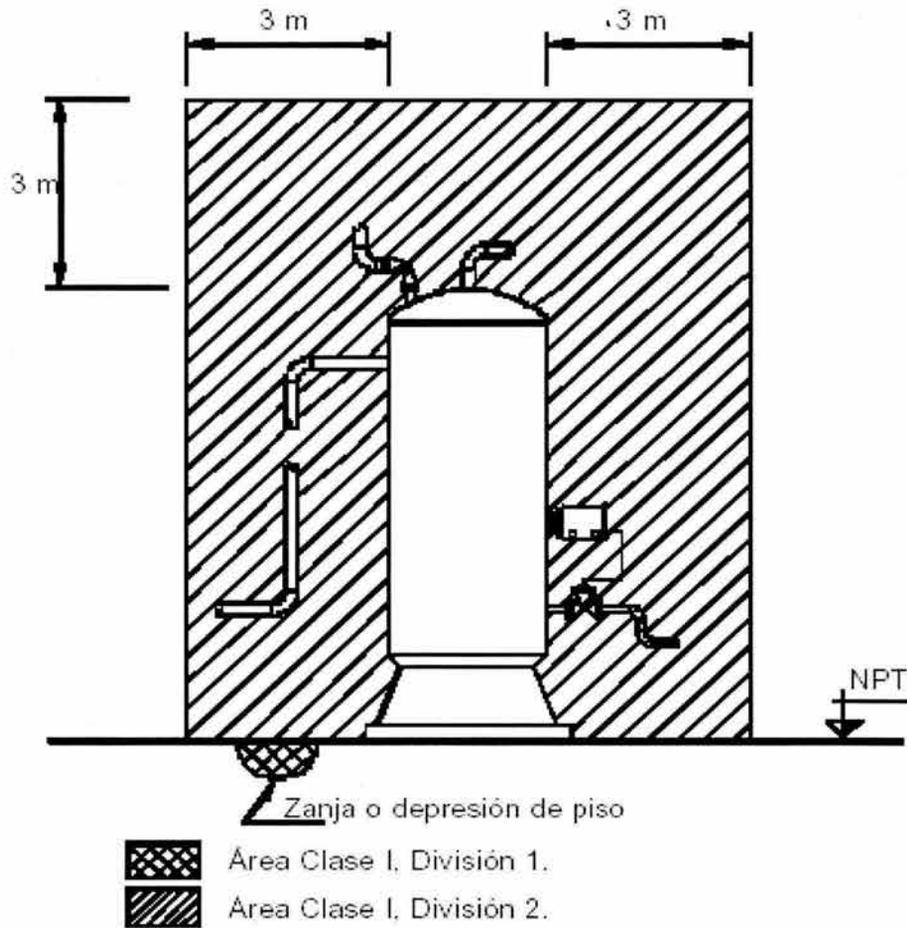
Tanque separador de hidrocarburos a presión, instalado en área libremente ventilada
